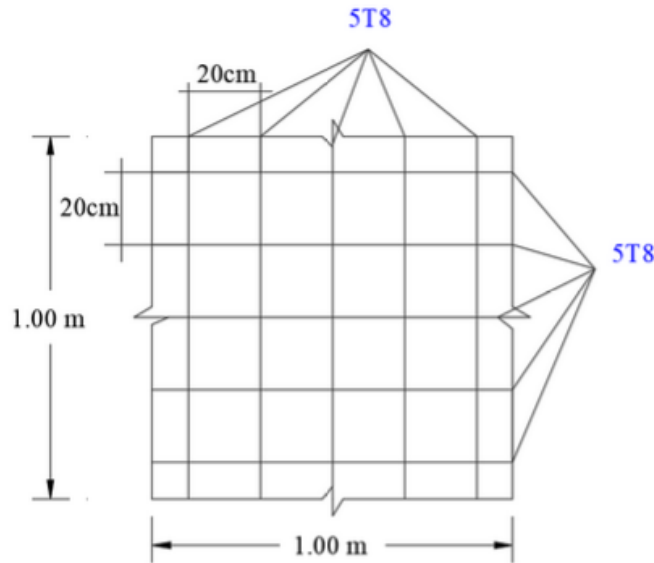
Schéma du ferrailage d'un m<sup>2</sup> de la dalle flottante
